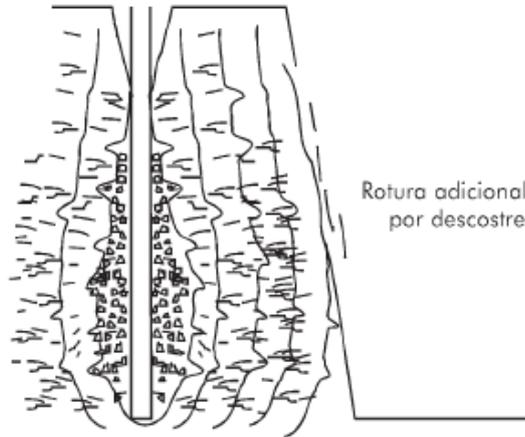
Interacción de las ondas transversales de esfuerzo.
